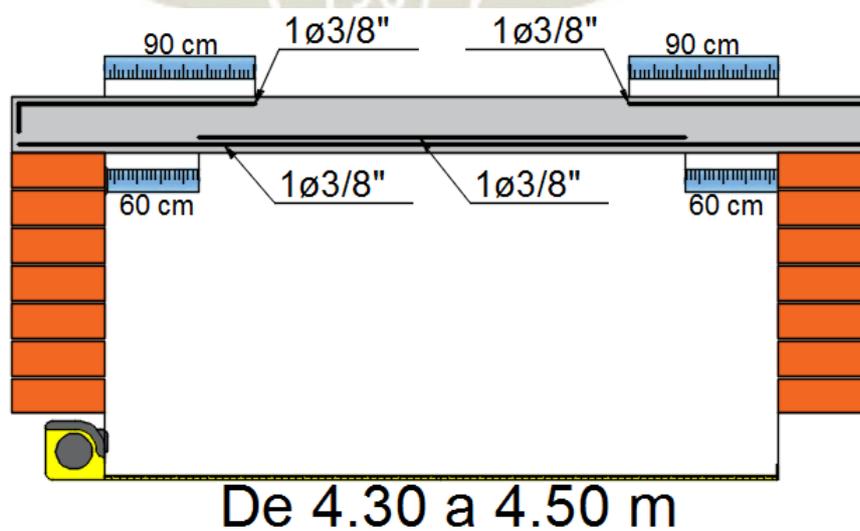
Refuerzo de vigueta hasta 4.50 m.
